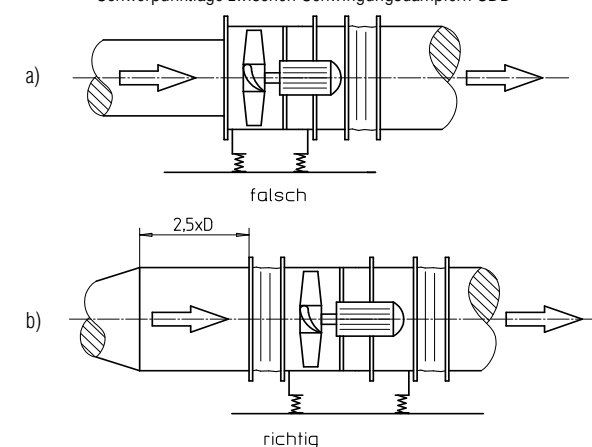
Funktioneller Einbau An- und Abströmung erfolgt mit Röhrleitung, Röhrstrecke vor und nach dem Ventilator 2,5 x D (D = Durchmesser-Ventilator)
